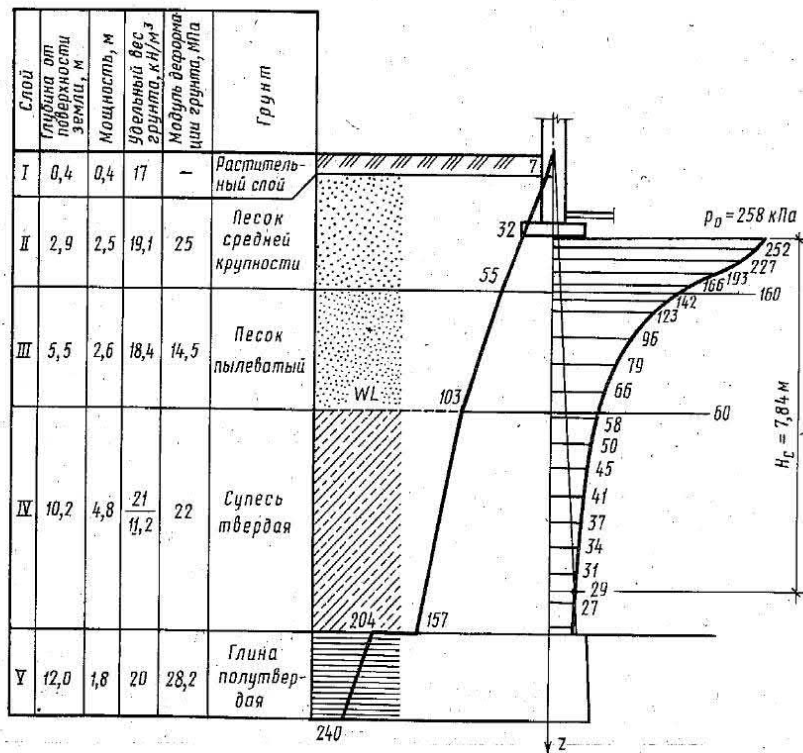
Схема к расчету осадки фундамента методом элементарного суммирования (пример 10.2)
